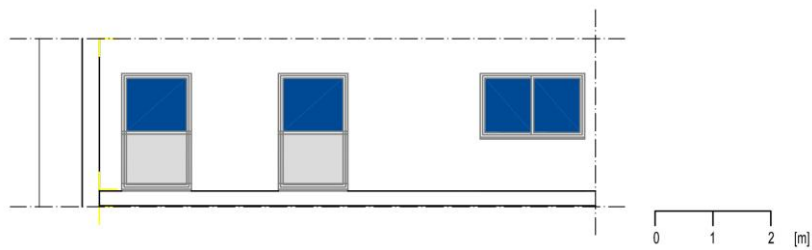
Secção do alçado norte (Fração 2.E.)
